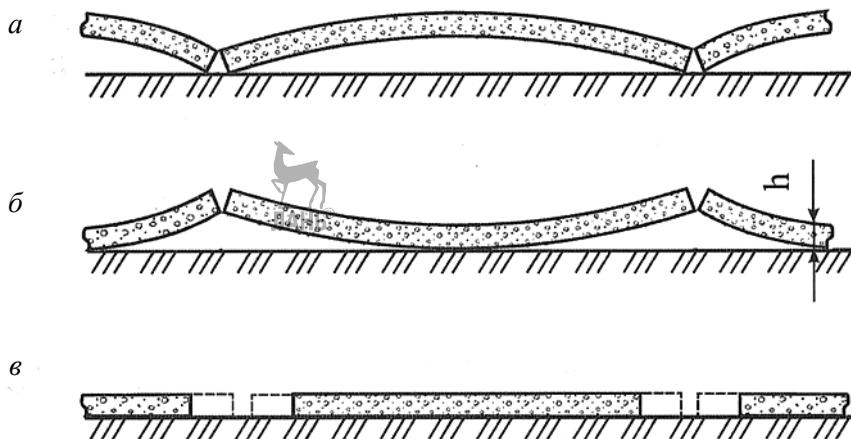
Температурные деформации плит бетонных покрытий:
